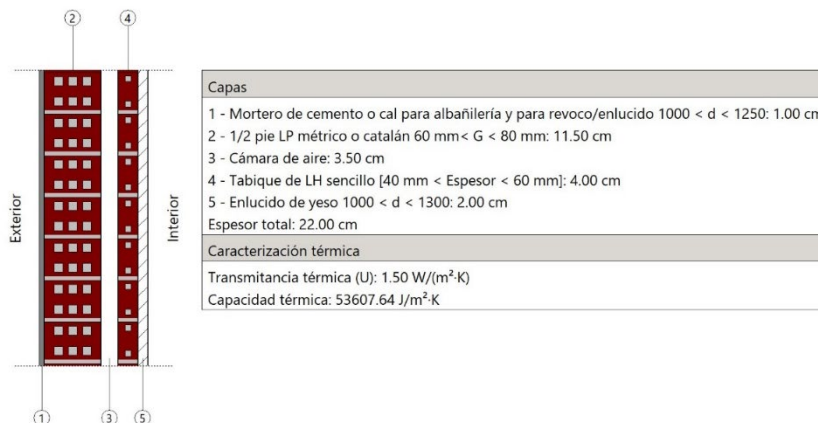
Detalle de muro de fachada (Elaboración propia, 2024)
